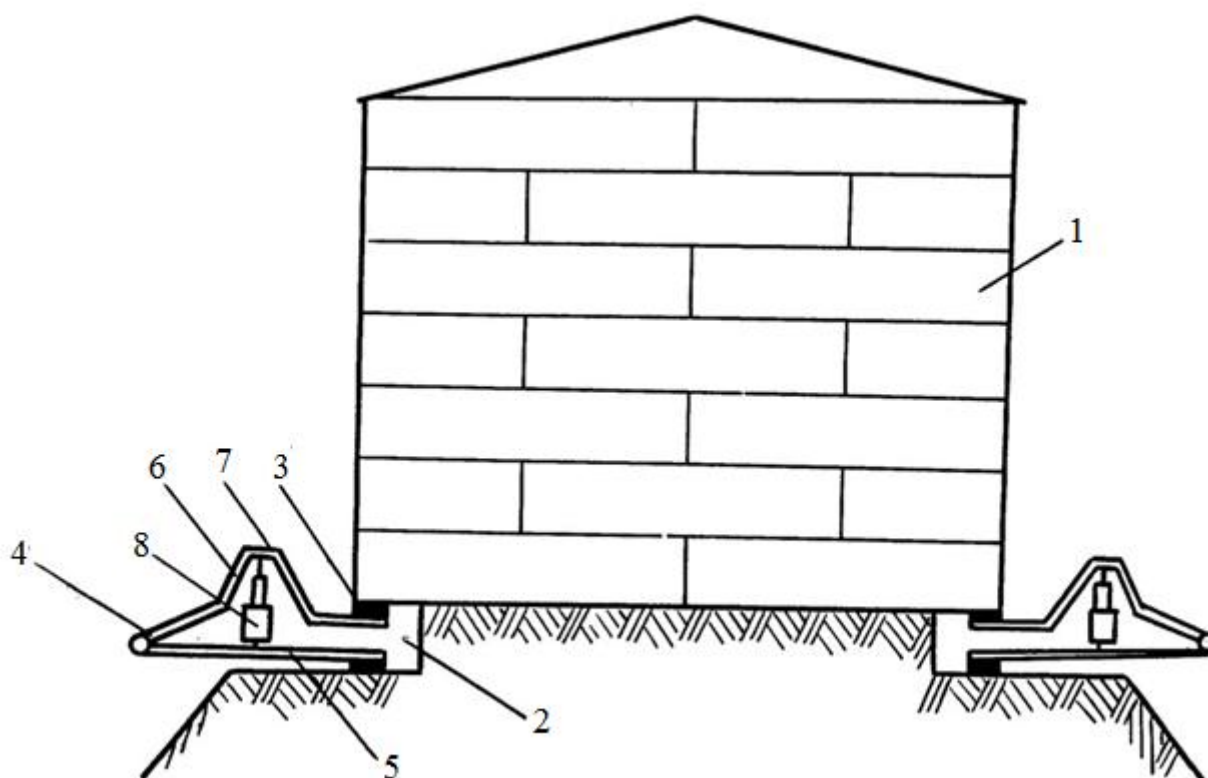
Общий вид устройства для восстановления проектного положения резервуара: 1 – резервуар; 2 – гнезда (ниши); 3 – опорный башмак; 4 – шарнир; 5,6 – рычаги; 7 – горизонтальная площадка; 8 – домкрат
